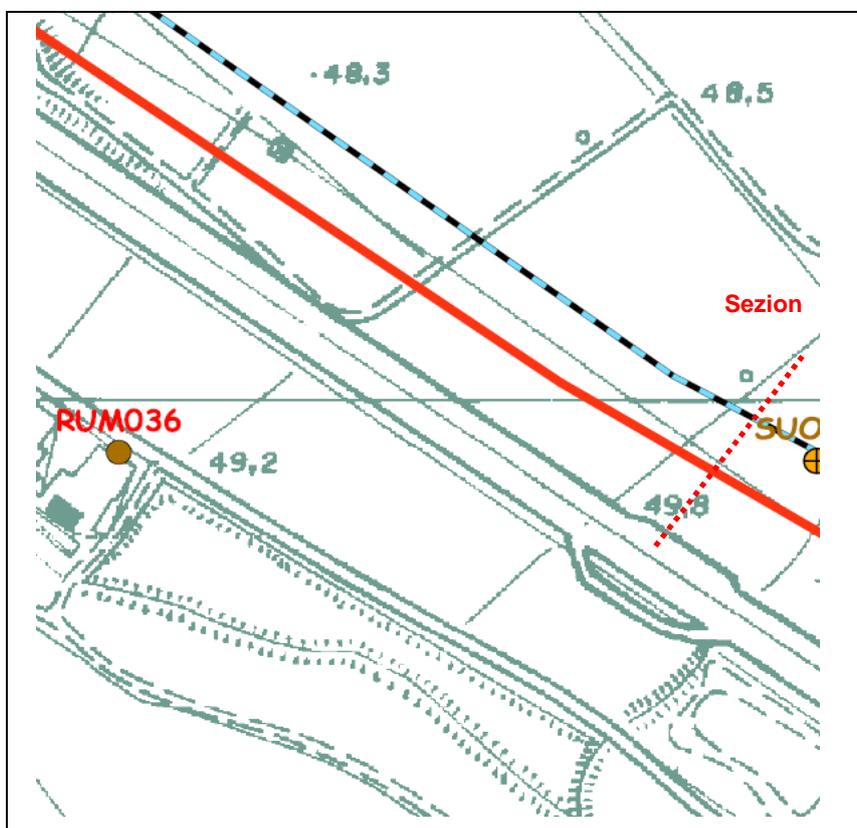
Stralcio planimetrico con indicazione della sezione di indagine
